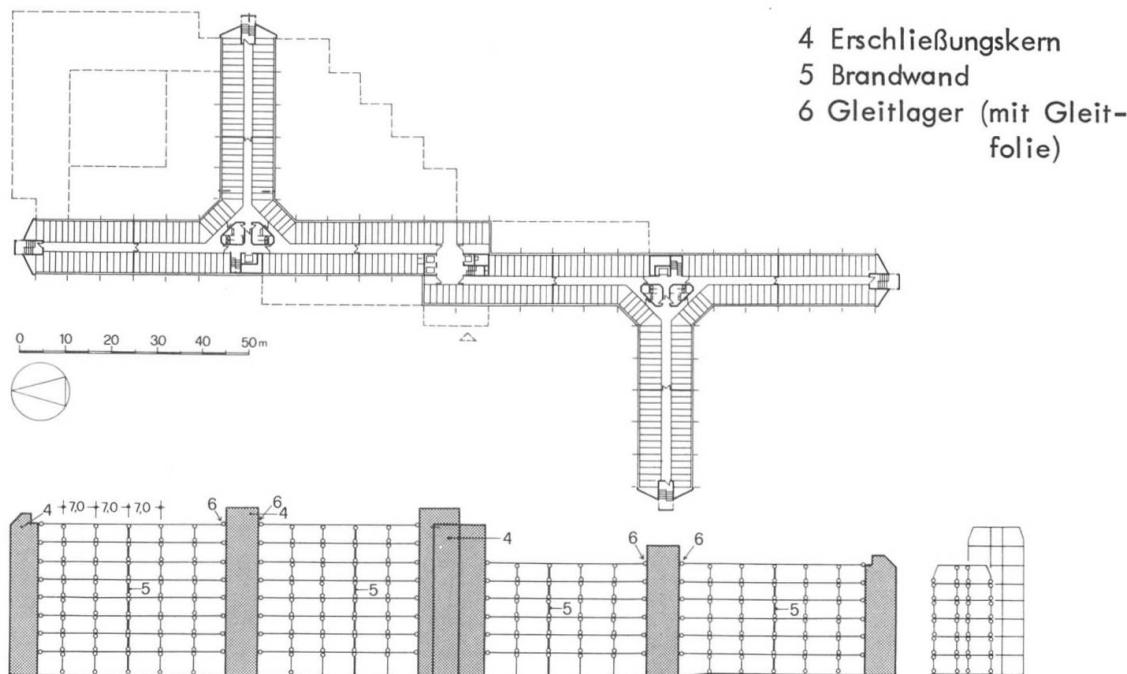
Grundriß Normalgeschoß, statisches System im Längs- und Querschnitt
